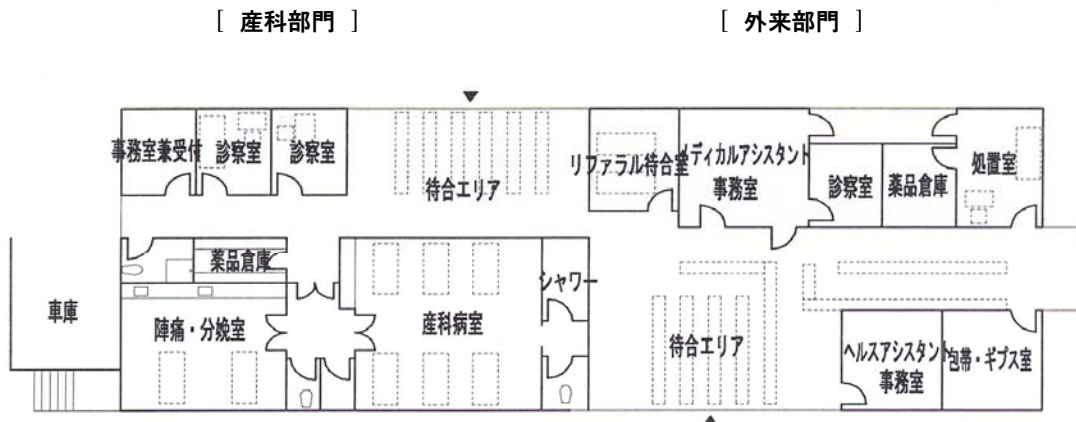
標準設計図(ムワジシヘルスセンター)平面図
